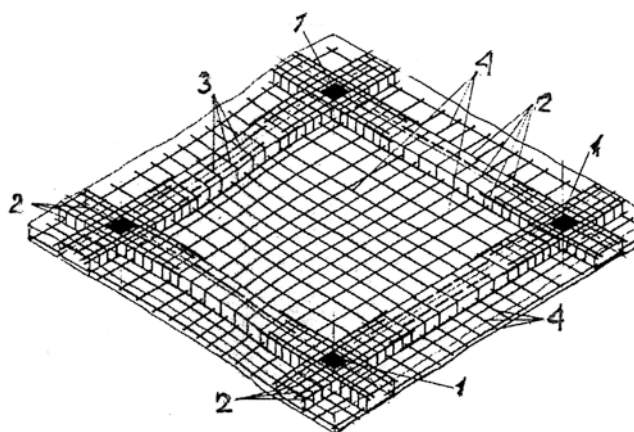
Схема ригельного армирования пространственными каркасами безбалочного бескапитального перекрытия: 1-место примыкания плиты к колонне; 2- верхнее продольное армирование скрытой балки; 3 – нижнее продольное армирование балки; 4 – арматура плиты.
